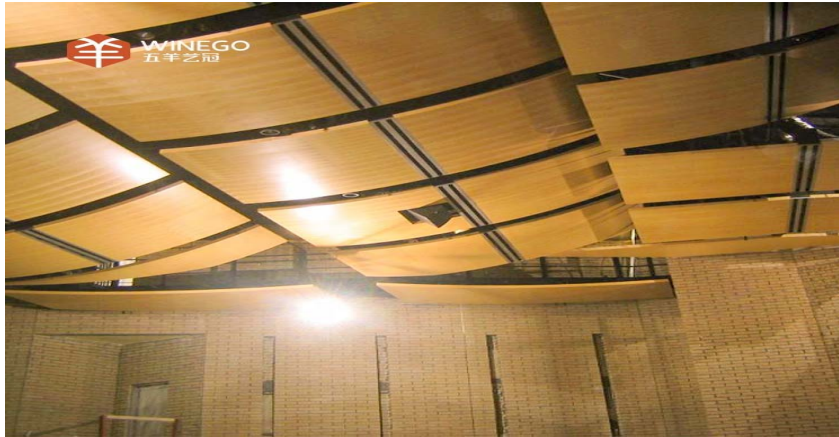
Paneles aislamiento acústico de madera para techos.
